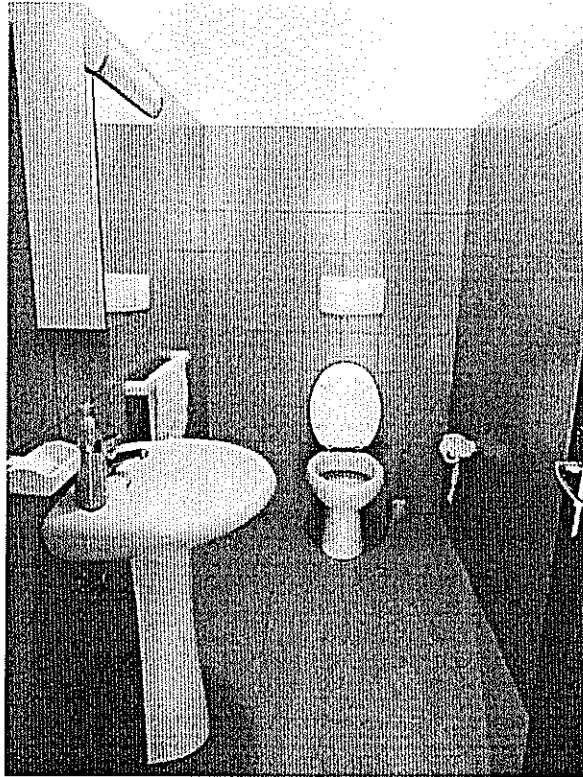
Wc dell'area amministrativa del primo corpo di fabbrica – piano terra.
